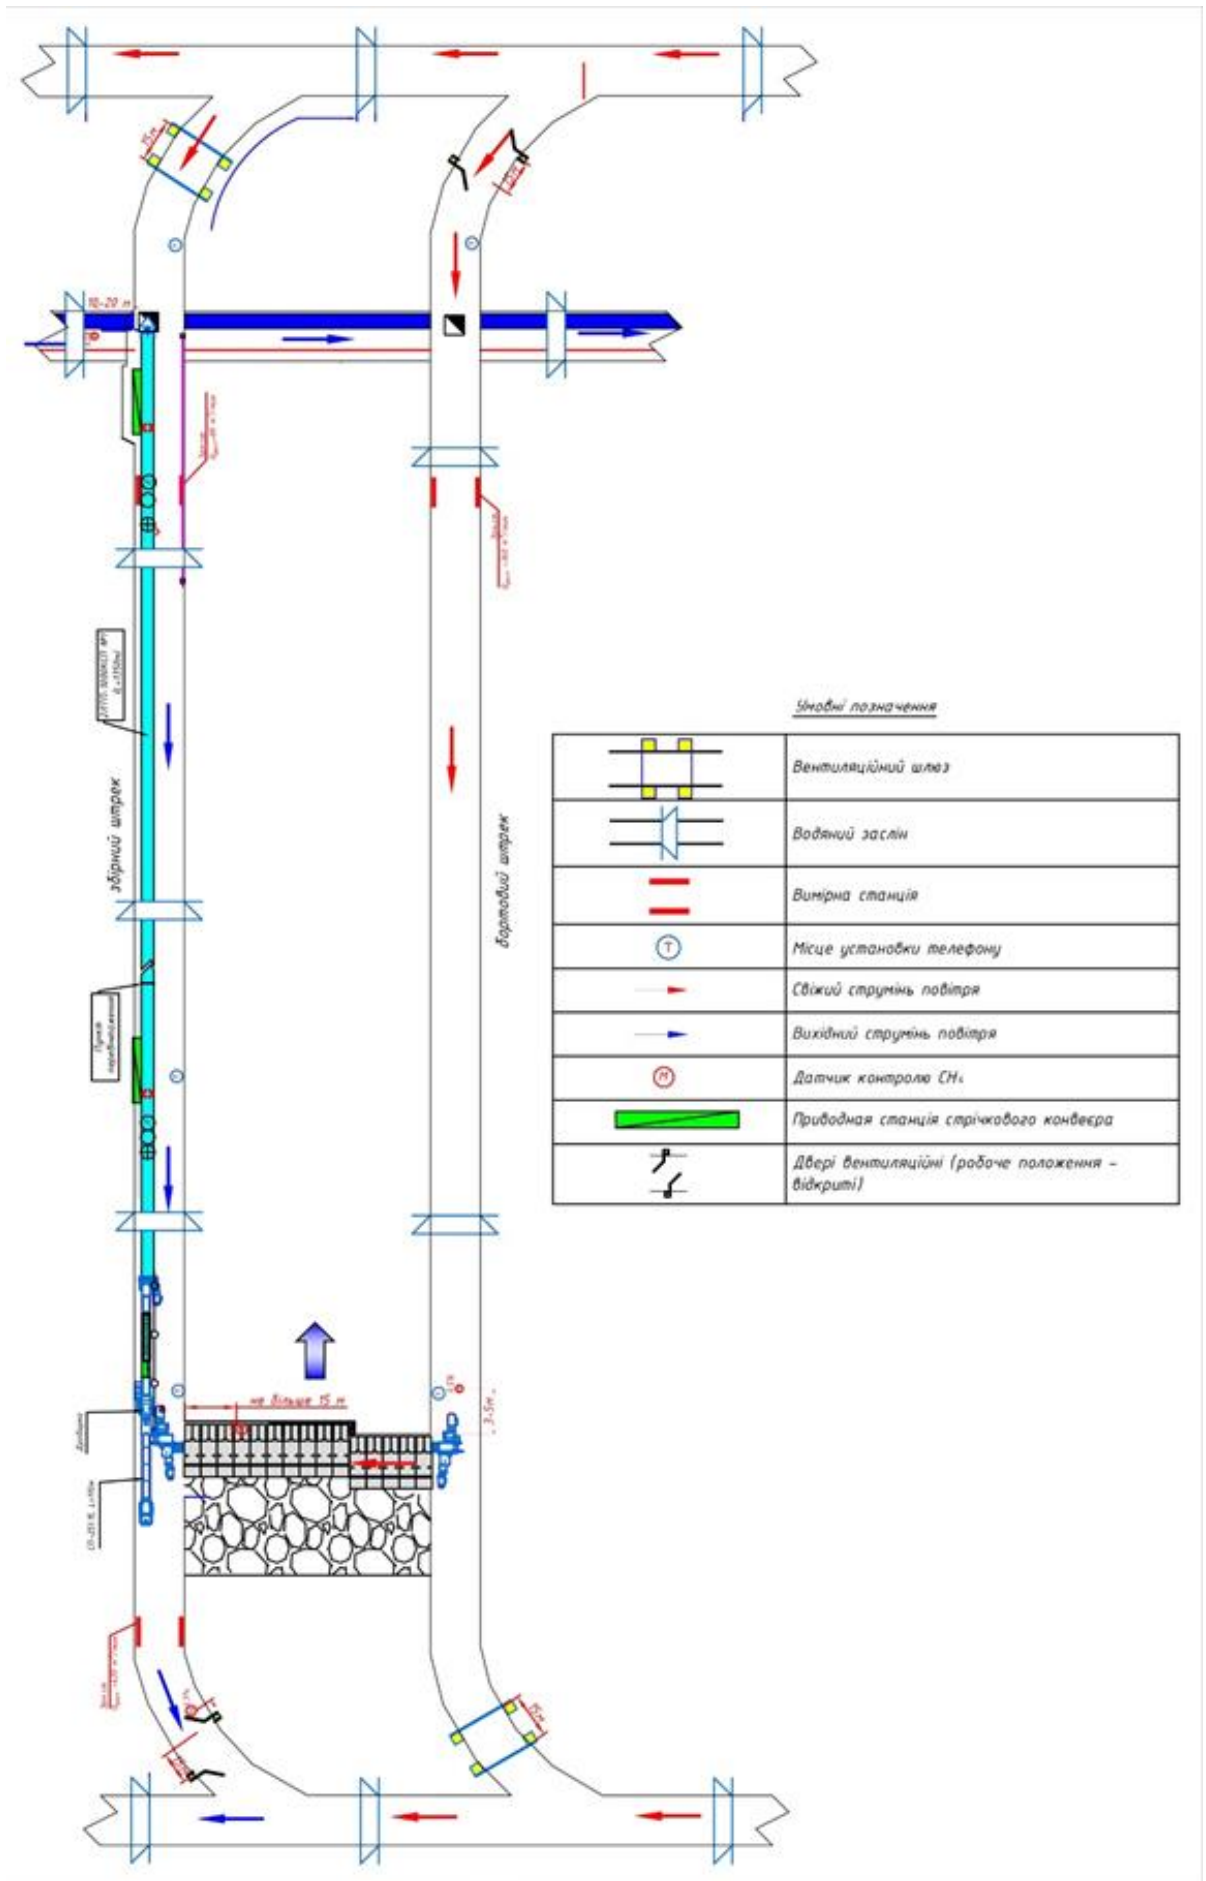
Схема провтрювання виїмкової ділянки
